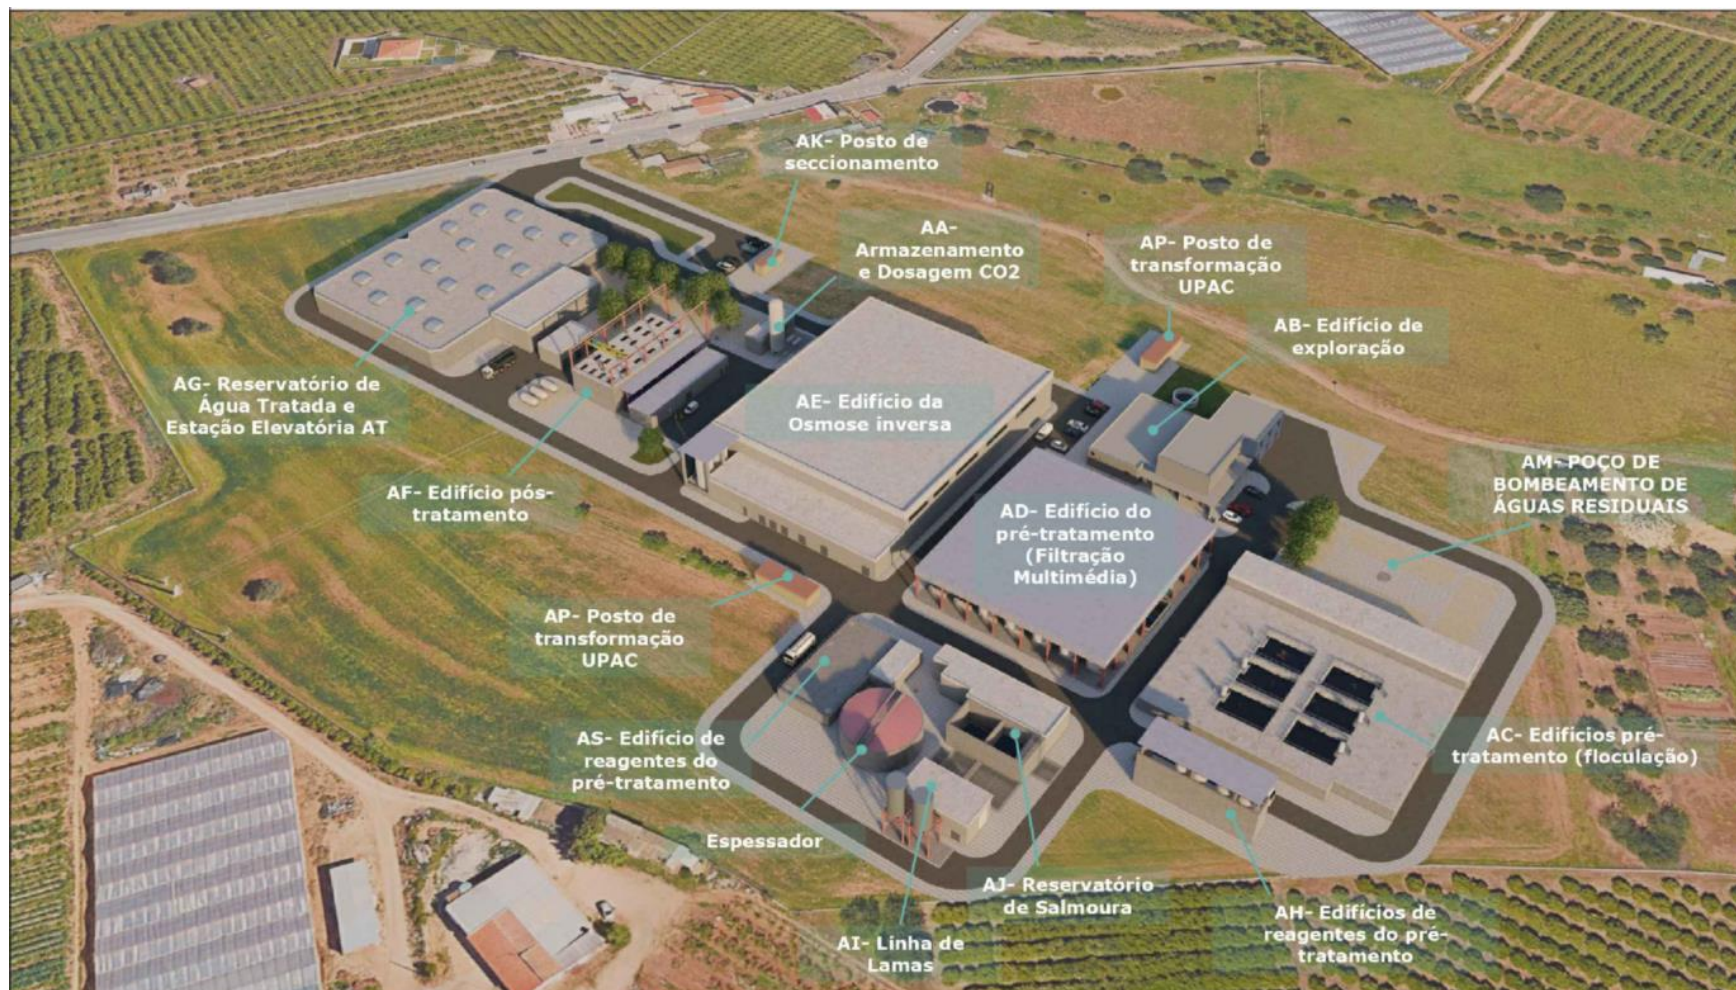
Vista geral da EDAM e dos elementos constituintes
